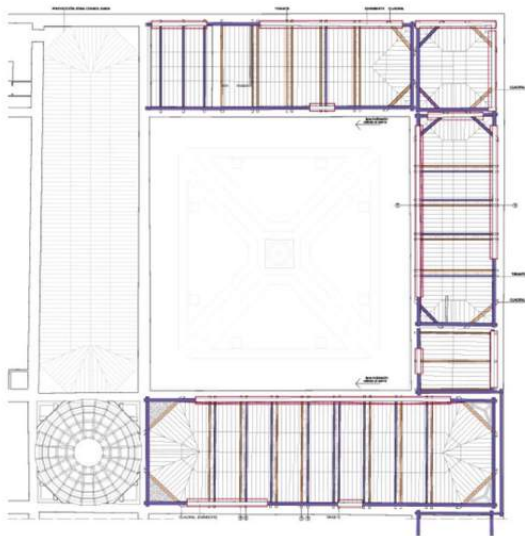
Hospital Real: restauración de las cubiertas. Plano de armaduras del Patio de los Inocentes, 2007.
